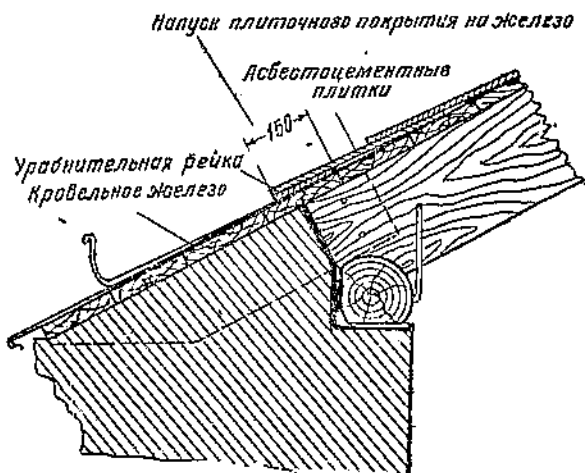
Устройство примыкания плиточного покрытия к карнизам настенных желобов (железным).
